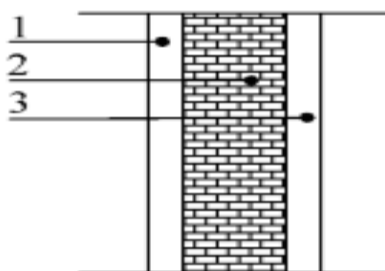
Coupe verticale d'un mur intérieur.
